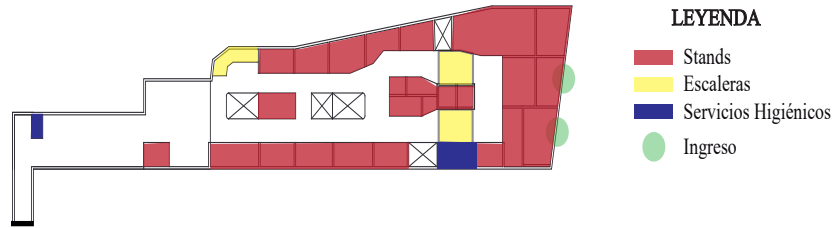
Plano de distribución de la galería Centro Comercial Geraldine, analizada en Mesa Redonda.⁷⁹
